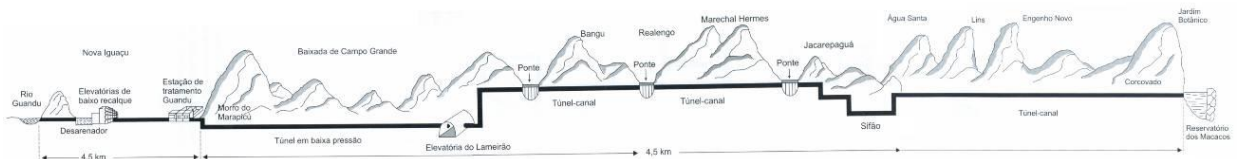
Traçado em planta e perfil do Túnel Guandu-Macacos.
